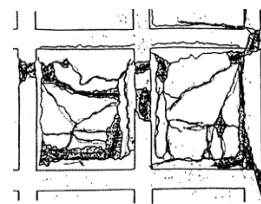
鉄筋コンクリート柱の座屈・インフィル壁の崩落
